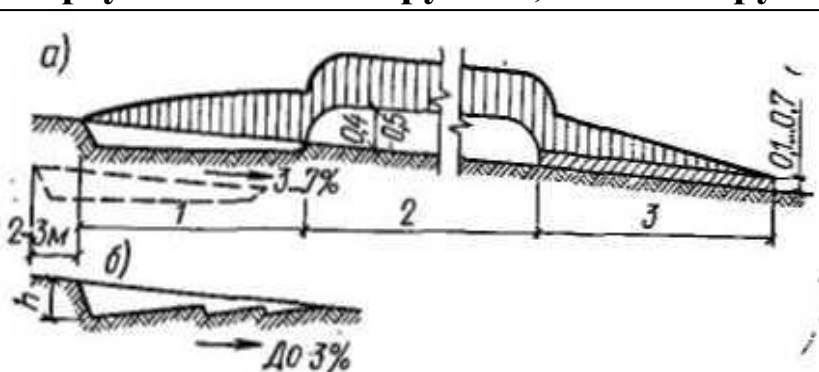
Схема загрузки, транспортирования и разгрузки грунта скрепером:
